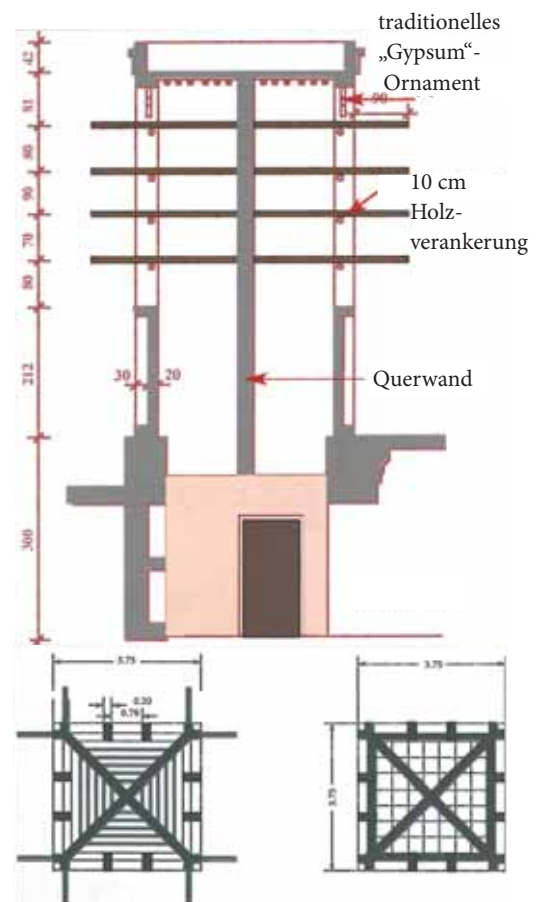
Schnitt und Grundriss eines Windturmes
